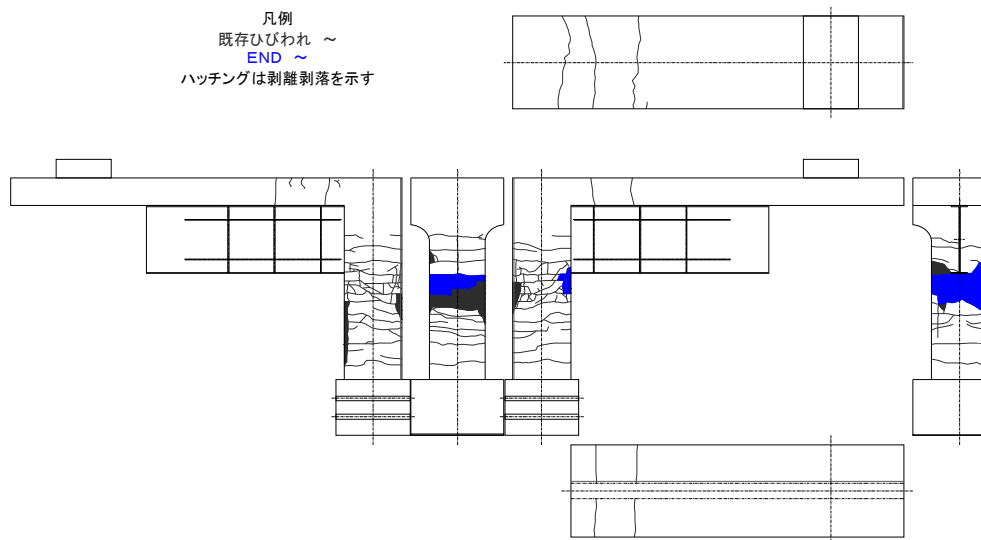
ひび割れ損傷図 (その3)
